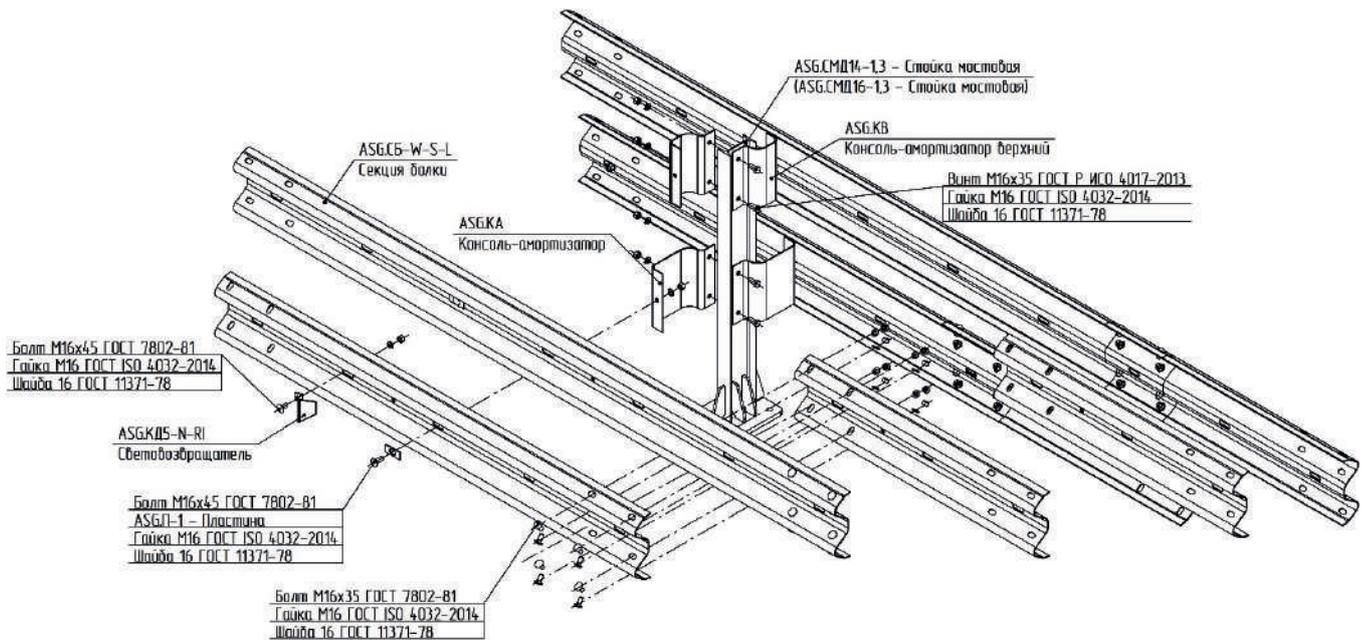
Схема сборки конструкции №39 и №40
